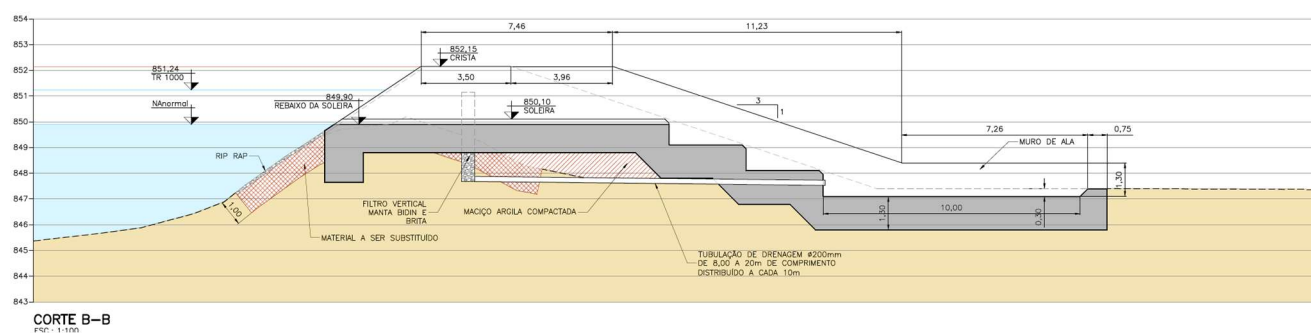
Perfil proposta para o sistema extravasor da Barragem São Pedro.
